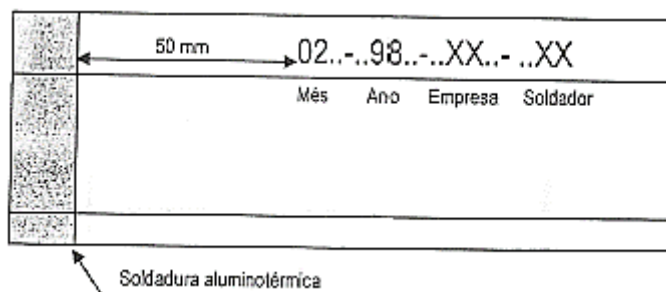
Forma de identificação da soldadura. [10]
